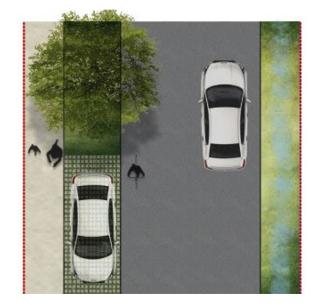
Coupe de principe d'une voie de desserte Source : DAO : GSP
